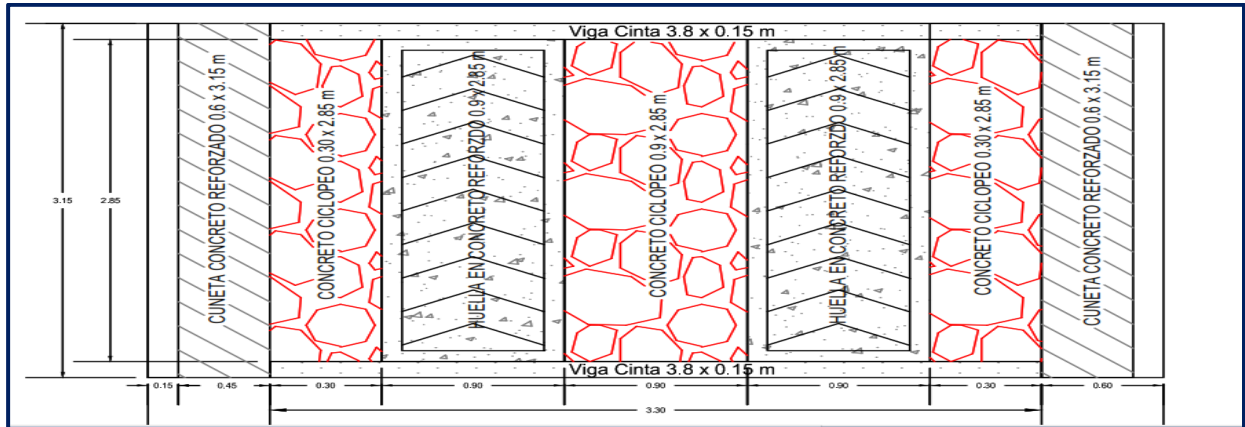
Vista de planta diseño placa huella de 4.5 m
